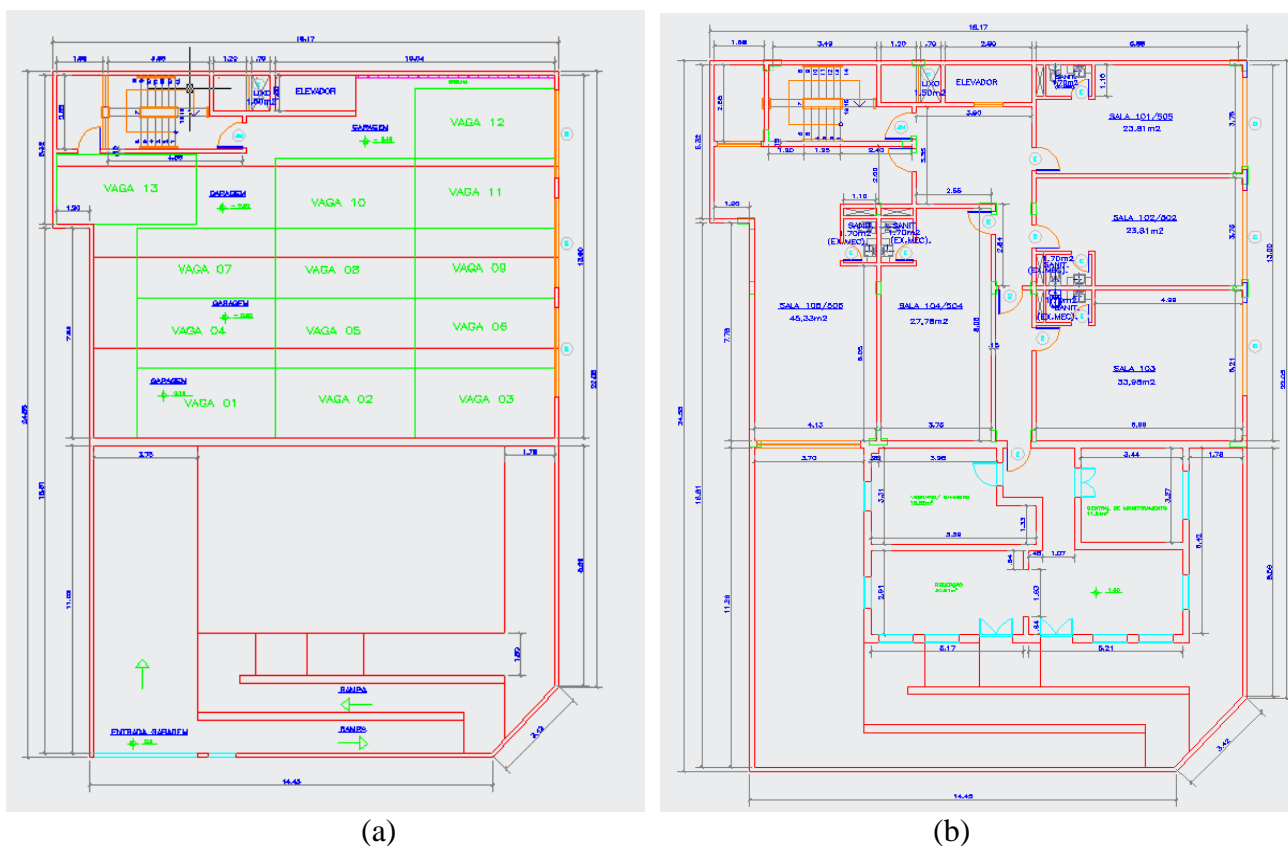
Planta Baixa: a) térreo; b) 1º pavimento tipo (2 unidades)
